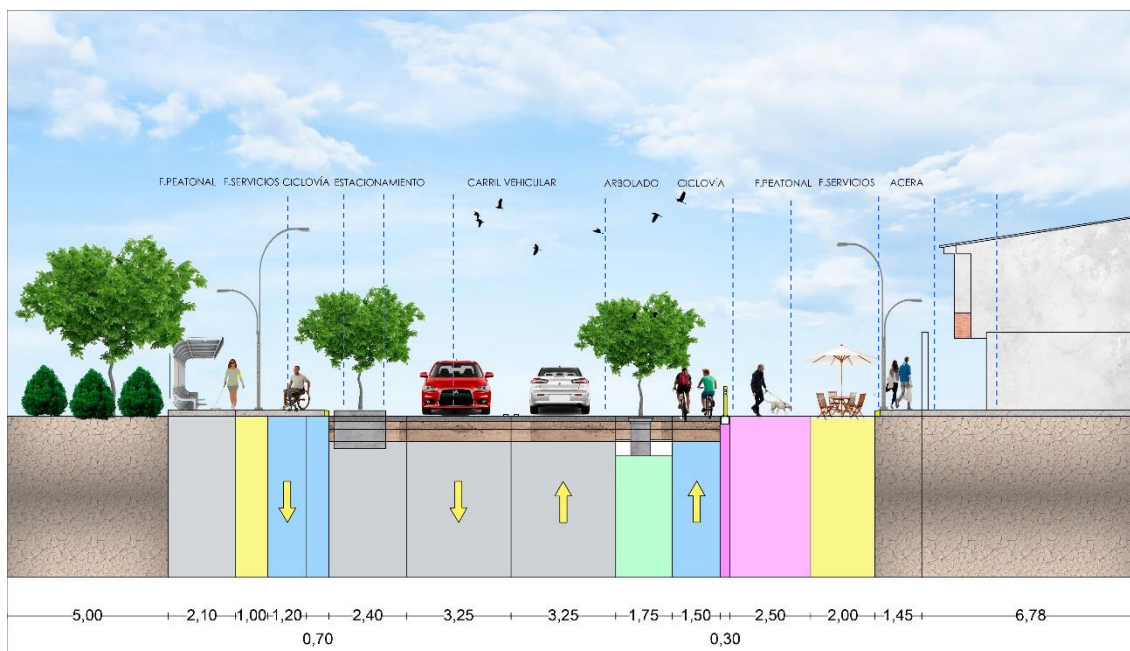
Sección A-A' (Corte vial tramo 1).
